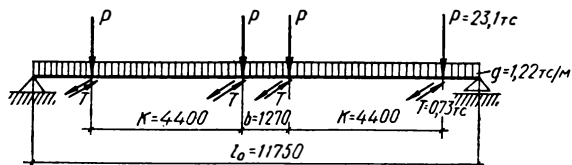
Расчетная схема подкрановой балки при загрузке двумя кранами.
